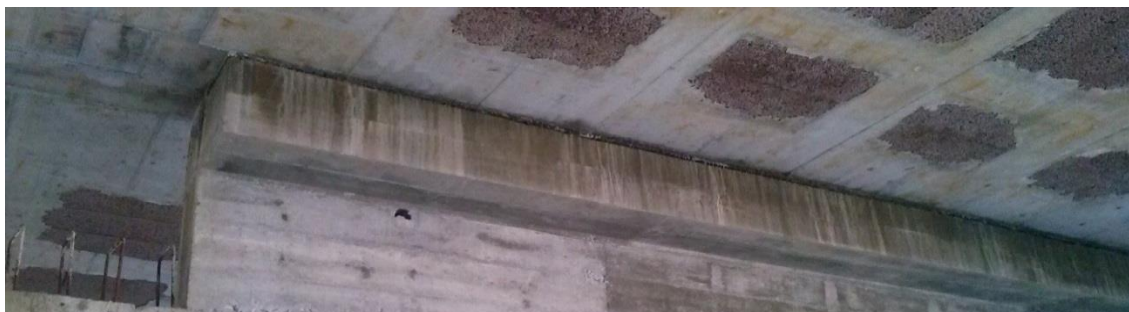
Zona de apoio da laje (Fonte: Autor)
